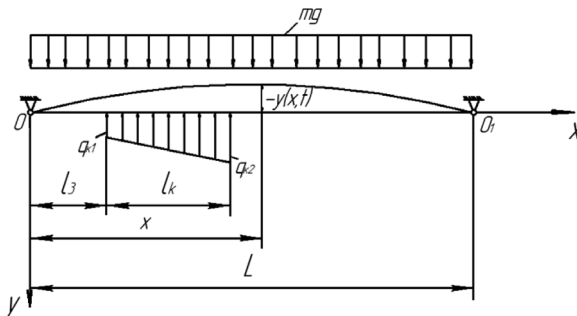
Расчетная схема блока кровли после хрупкого разрушения
